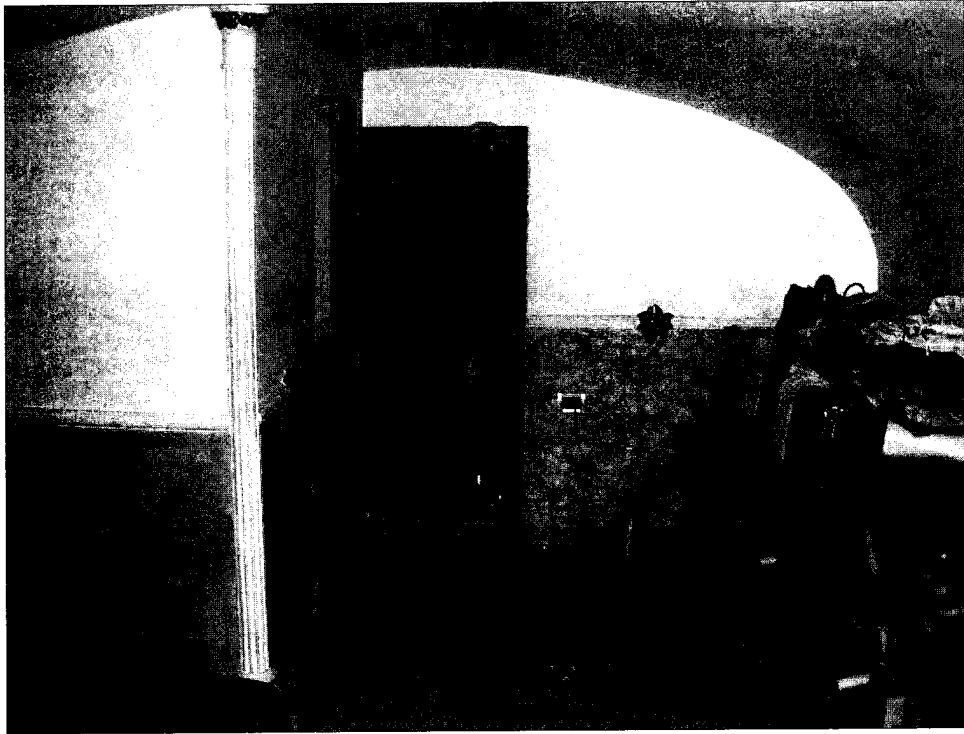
Porzione unità i. 1: piano soppalcato
